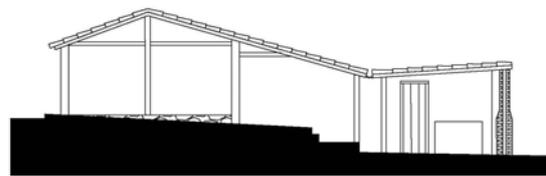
Fachada Oeste (Acervo PROAU/FAU/UnB).
